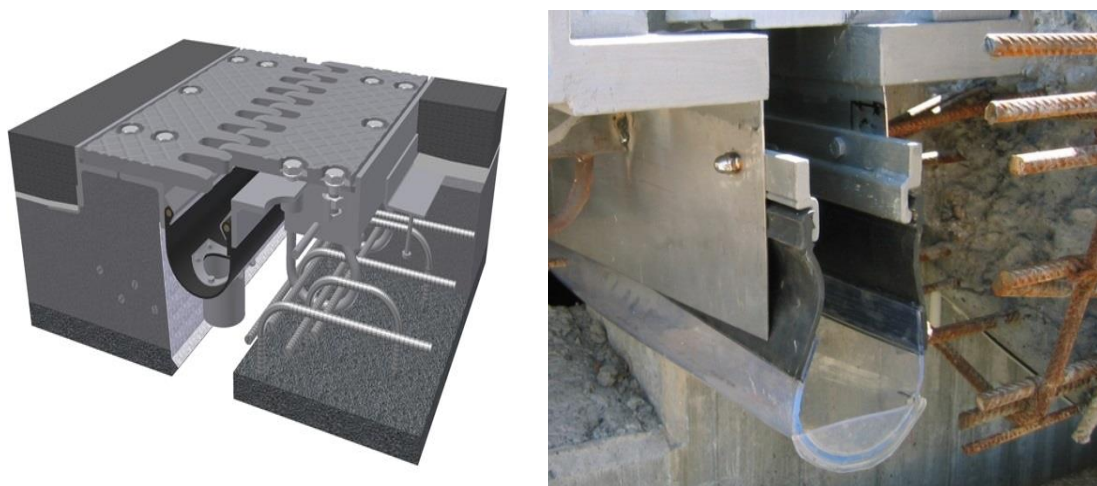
Junta dentada com calha em esquema (à esquerda) [28] e real (à direita) [29]
